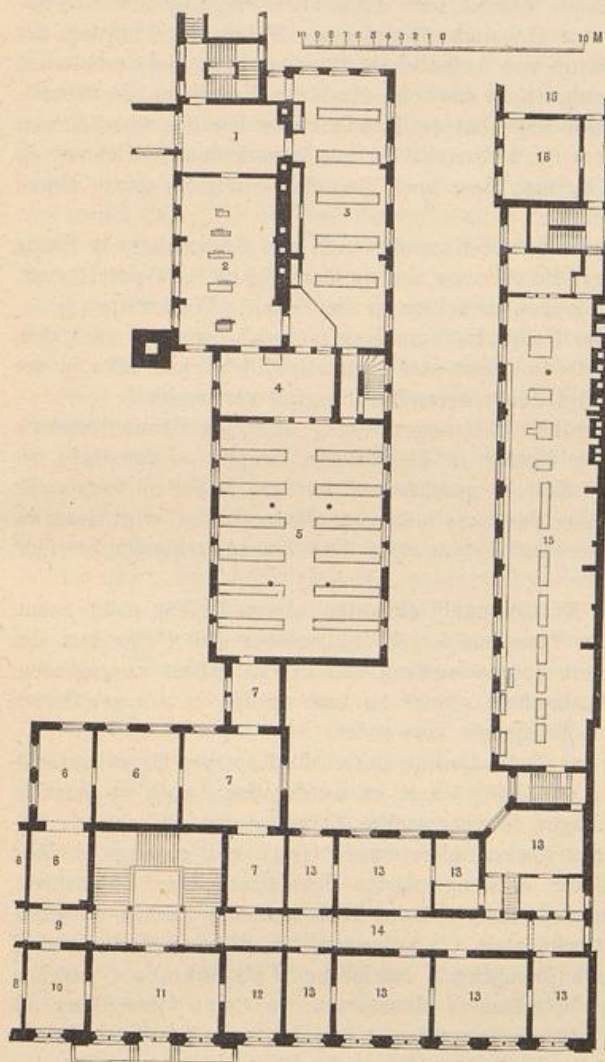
Grundriss des ersten Stockwerkes.
